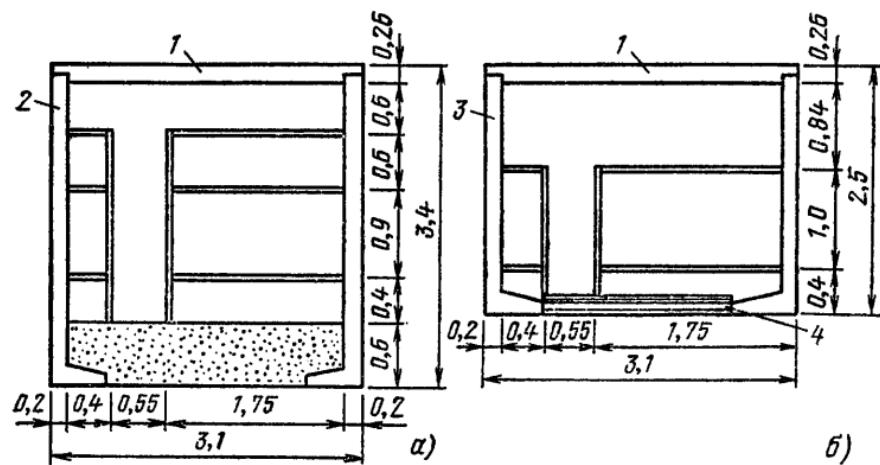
Наиболее целесообразное сочетание стенных блоков (деталей) и плит перекрытия сухих коллекторов:
